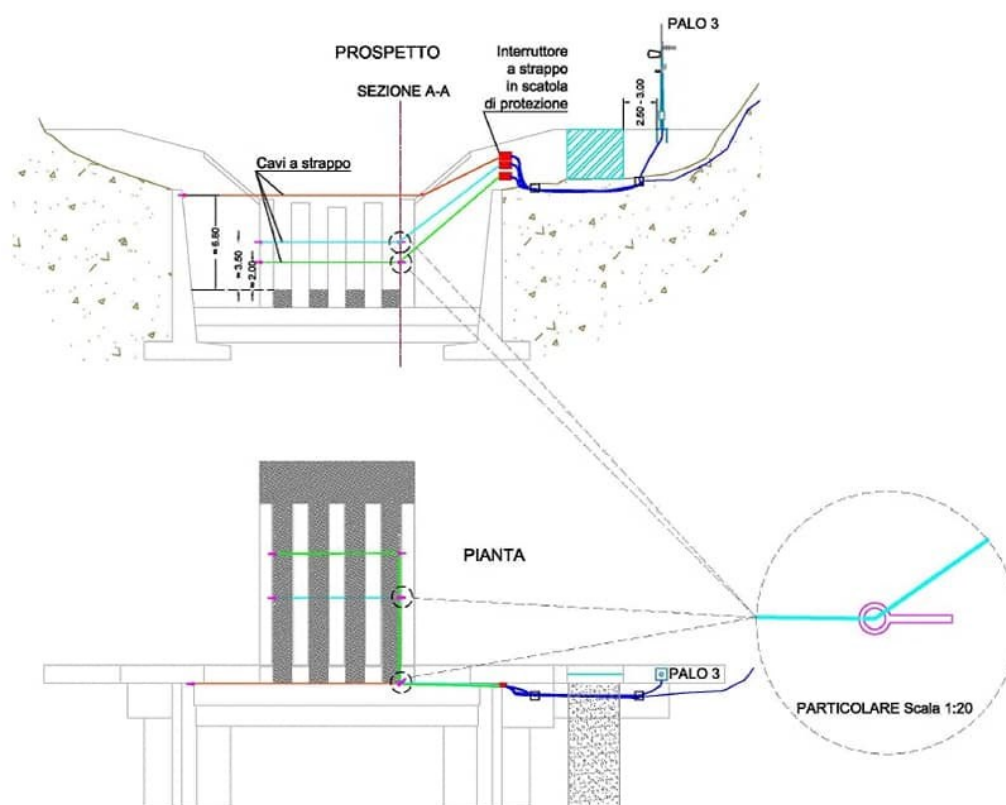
Prospetto dei cavi a strappo (Bottacin)
